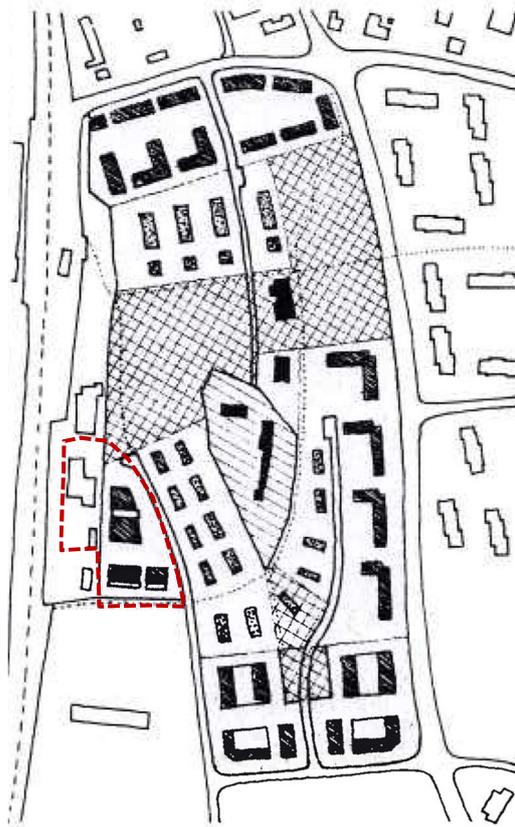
Gesamtkonzept «Schlossberg», Studienauftragsperimeter rot markiert (Quelle: Planungsbericht zum Bebauungsplan Schlossberg)
